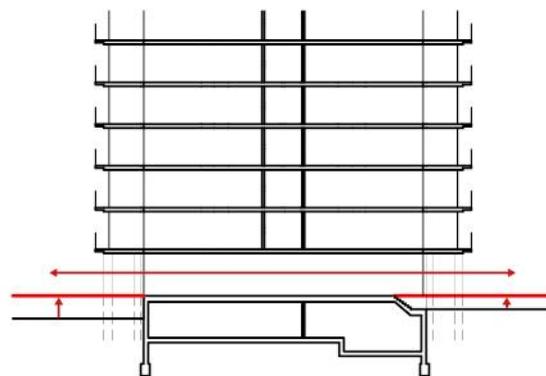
Coupe transversale Tour Bois le Prêtre avec sol extérieur nivelé au rez-de-chaussée
